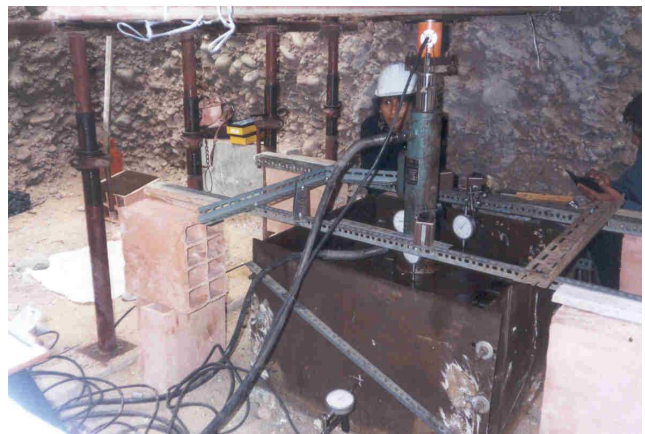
Muro de reacción para la aplicación de la fuerza horizontal
